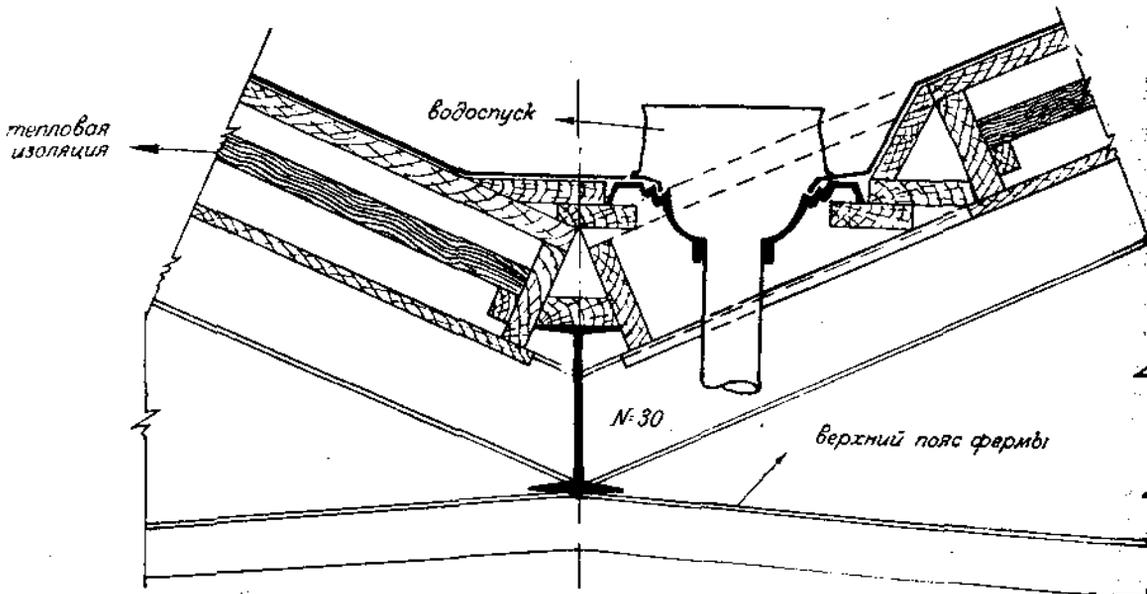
Деталь перехода на плоской части кровли к наклонной.
